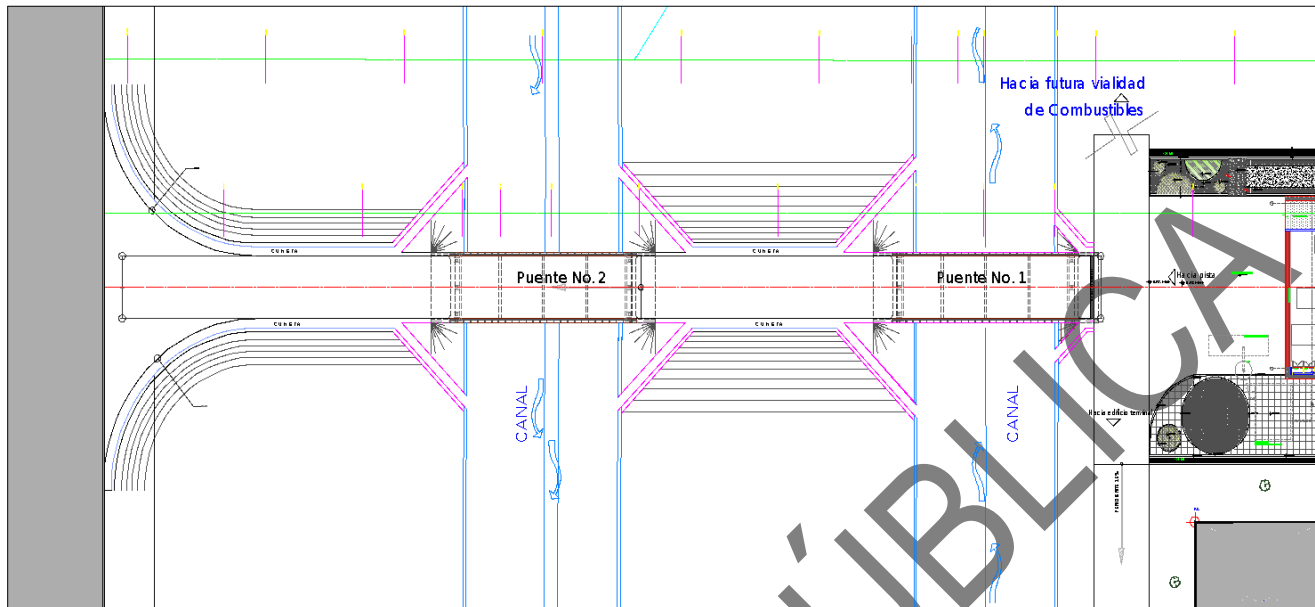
Planta arquitectónica de vialidad y puentes SEI-Pista 09-27.
